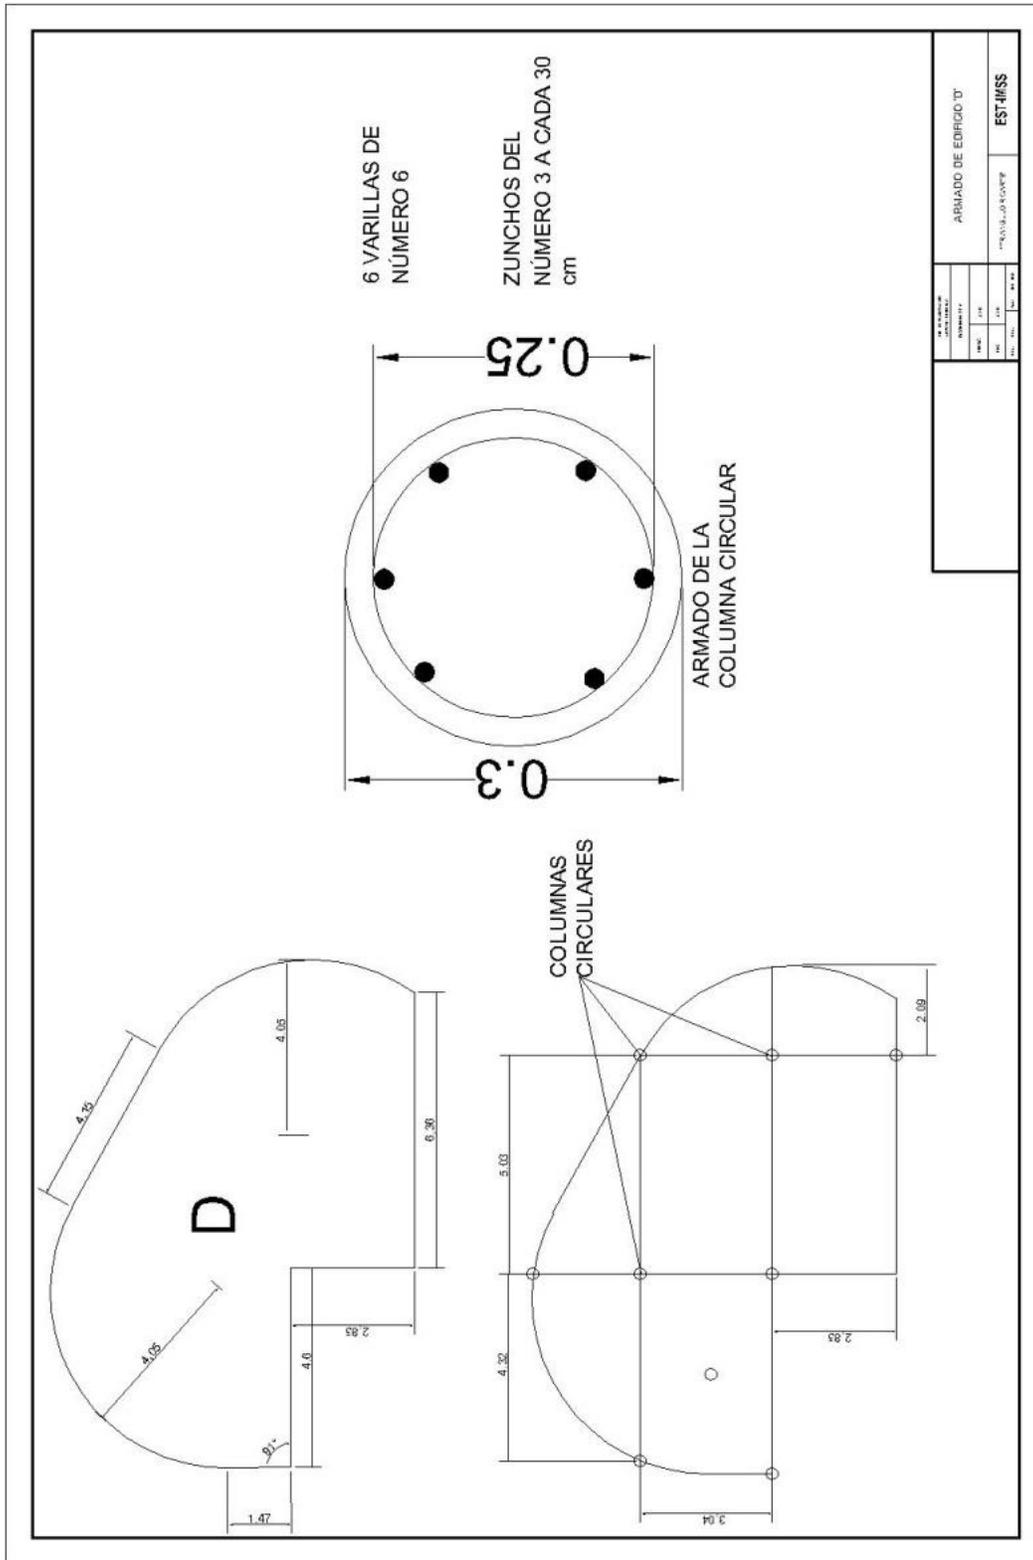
Plano de columnas de edificio "D" (fuente: dibujo hecho por el autor).
